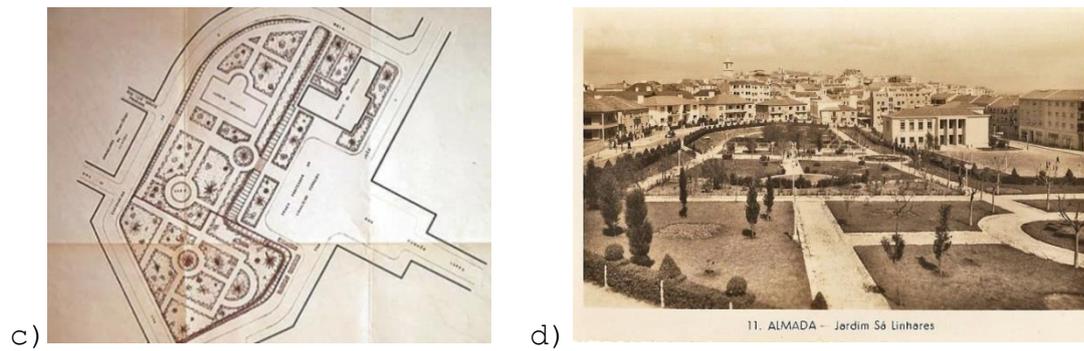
c) Planta do centro Cívico d) Fotografia do primeiro edifício a ser construído no centro cívico.
